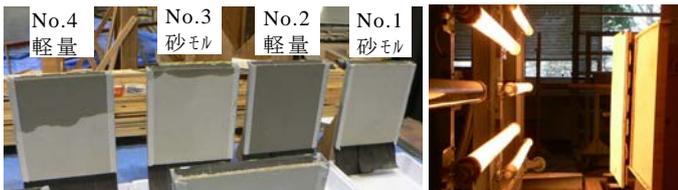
モルタル内部への浸透状況 写真-2 No.16 のランプ照射
